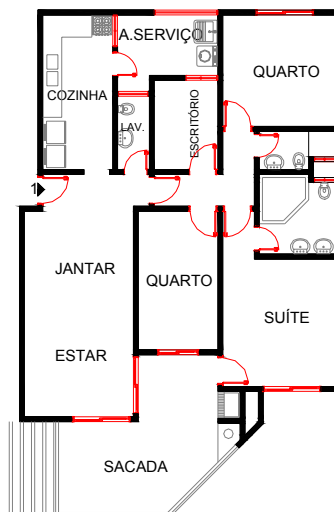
Planta Baixa dos apartamentos 302, 401, 402, 502, 601 e 901 - Estudo de caso E.
